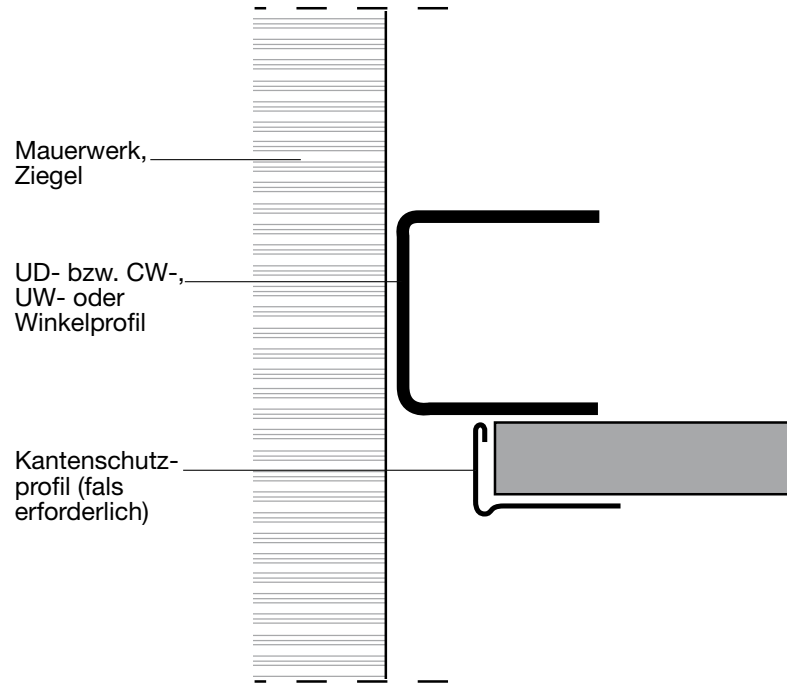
Anschluss abgehängte Decke zur Wand, konstruktiv
